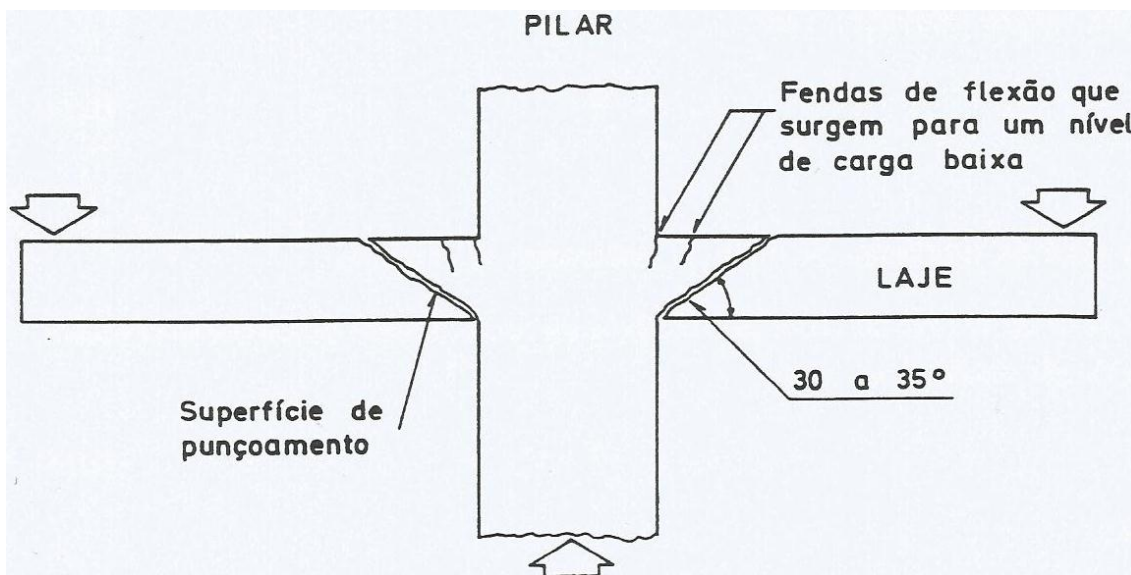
Mecanismo de rotura por punçoamento de um pavimento de laje [12].
